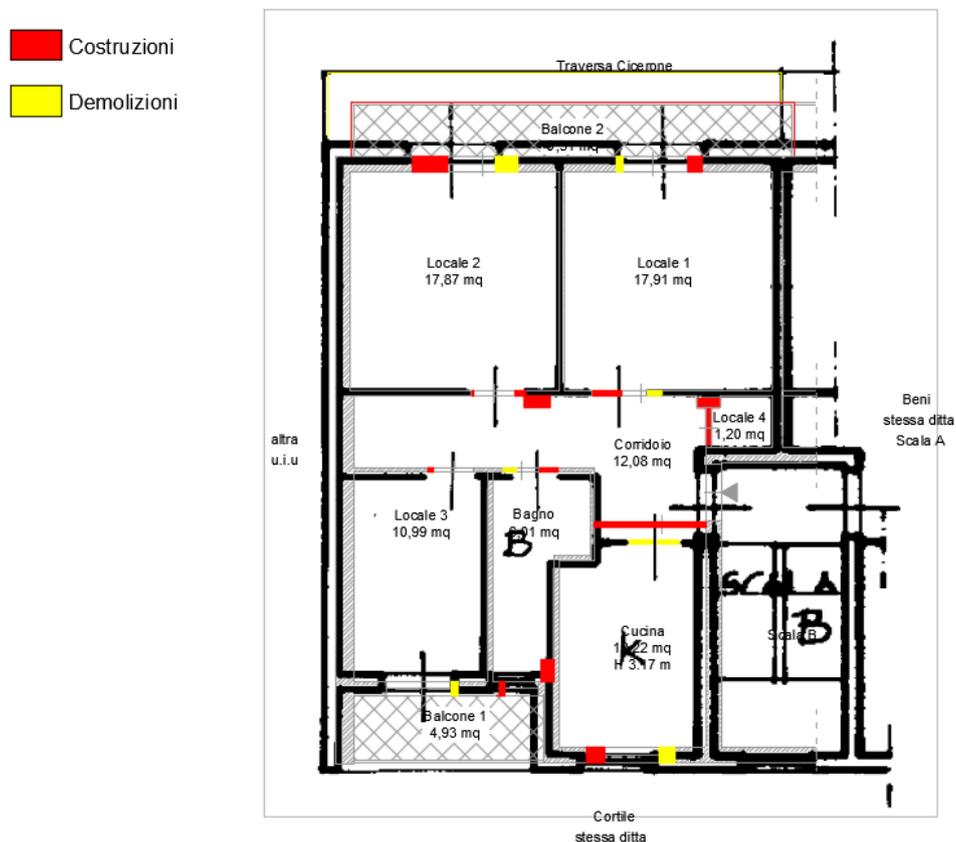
Confronto con planimetria catastale (Foglio 4, p.lla 1225, sub. 11)
